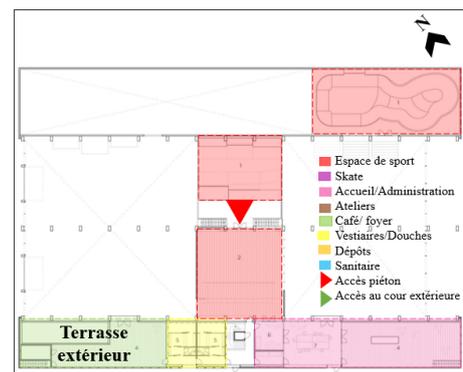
Plan de R+1 (Source: Archidaily.com (traité par l'auteur))
